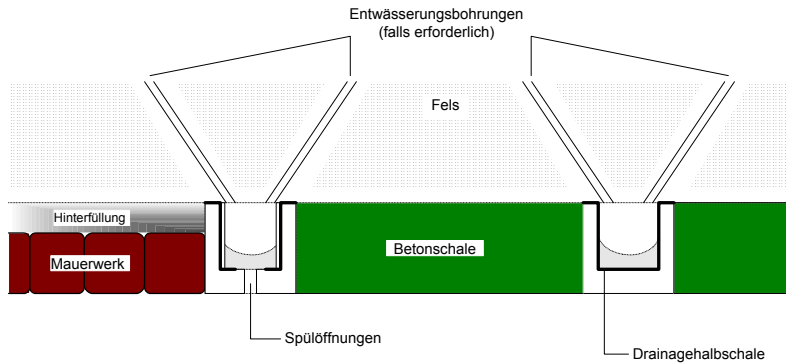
Drainageschlitz mit zusätzlichen Entwässerungsbohrungen
